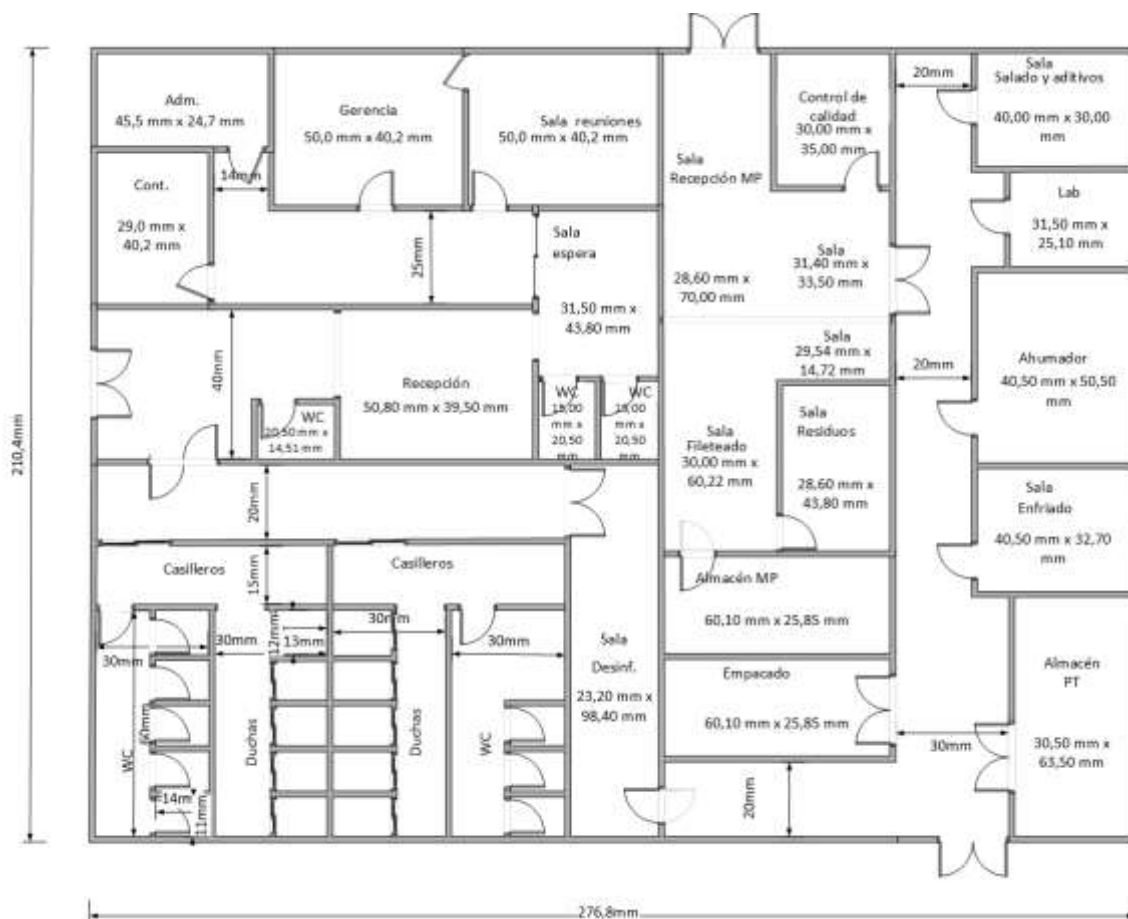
Estructura (layout) de las dimensiones requeridas a escala de la planta piloto con volumen de pesca artesanal.
